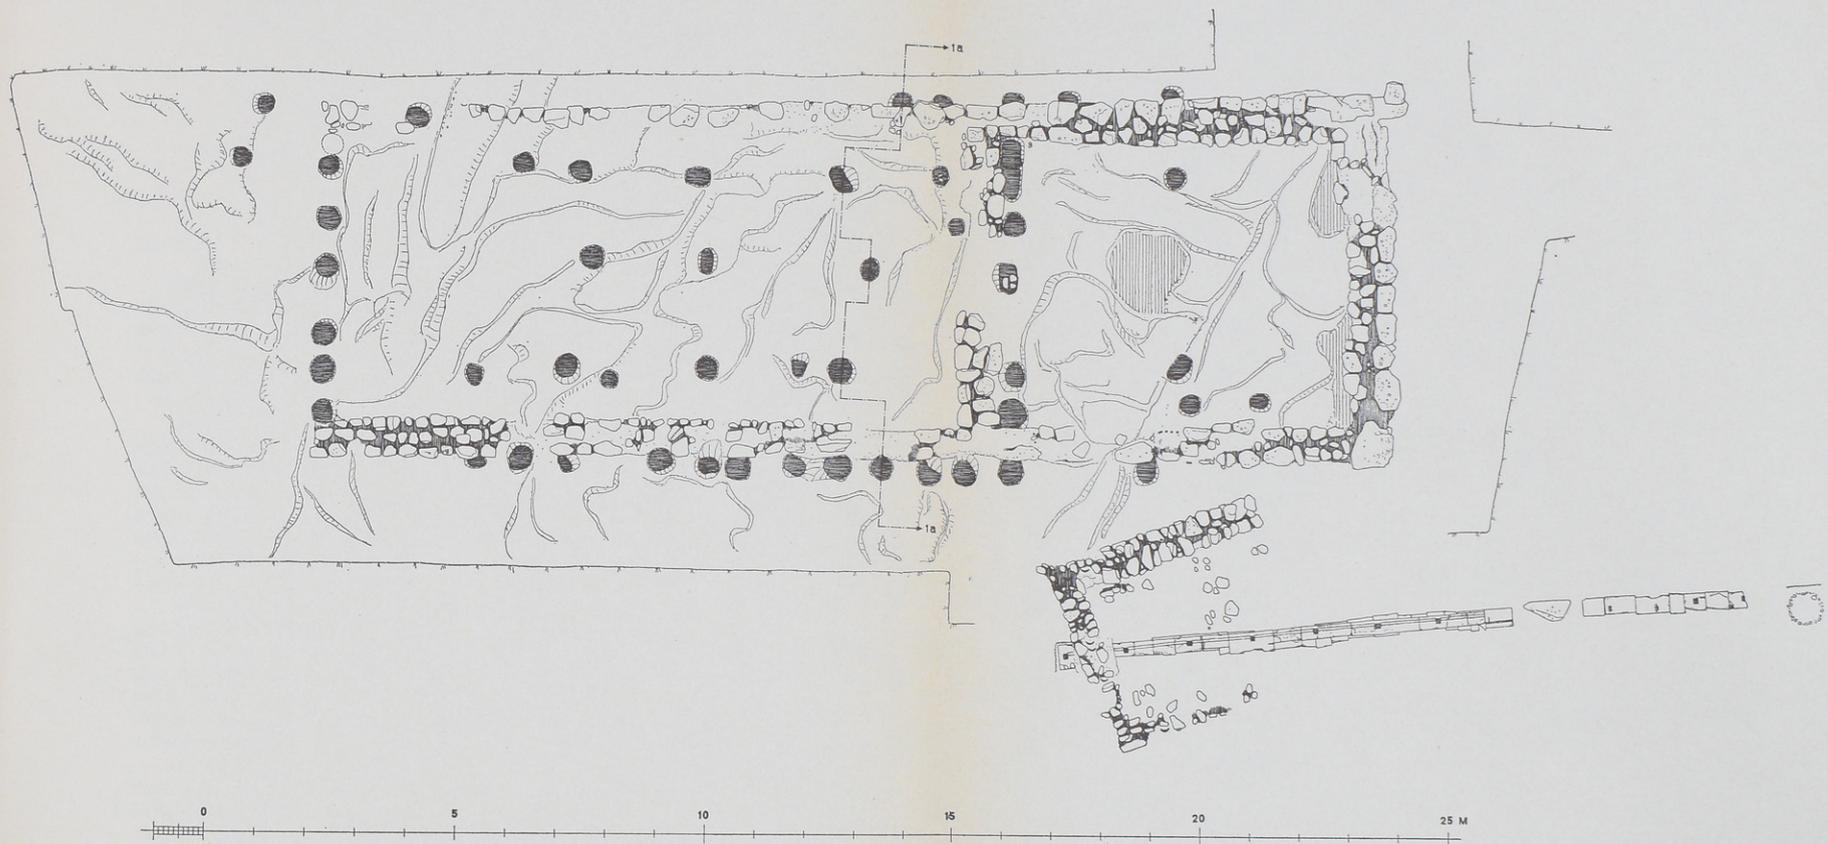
Bau III. Grundriss M 1:100.
